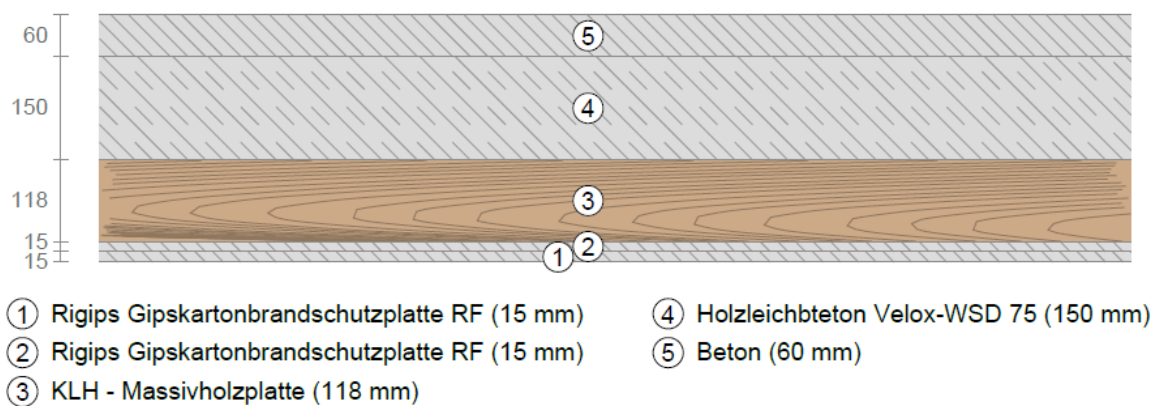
Deckenaufbau Holzleichtbeton. Erstellt mit U-Wert.net
